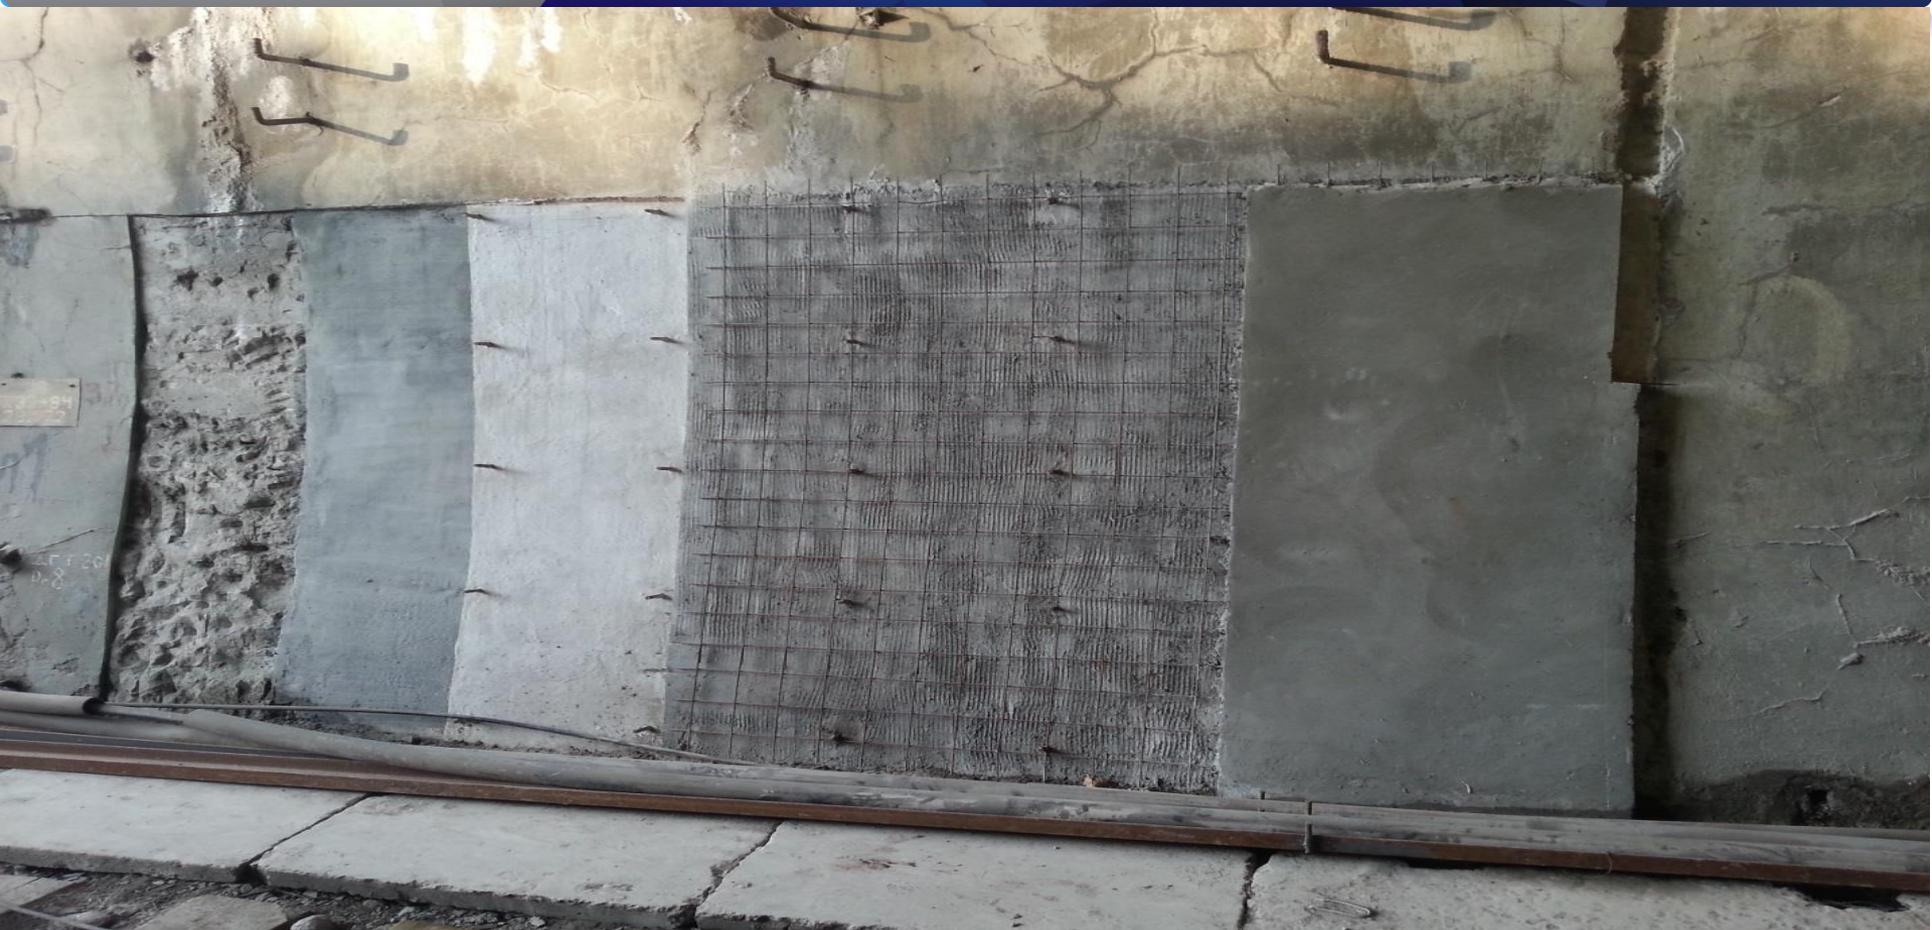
Опытный стенд. Устройство гидроизоляции несущей "стены в грунте" при поэтапном сооружении двухслойной бетонной конструкции типа «сэндвич» со средней гидроизоляционной прослойкой с двухсторонней адгезией
